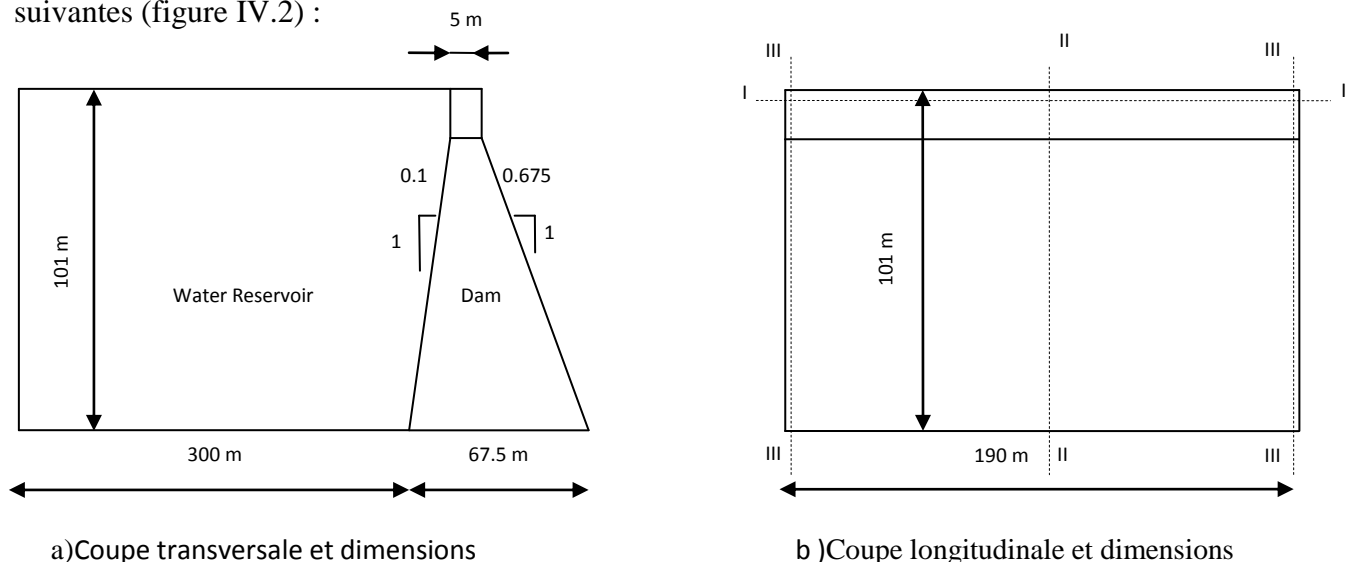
Sections et dimensions du barrage-poids en béton de Oued Fodda
